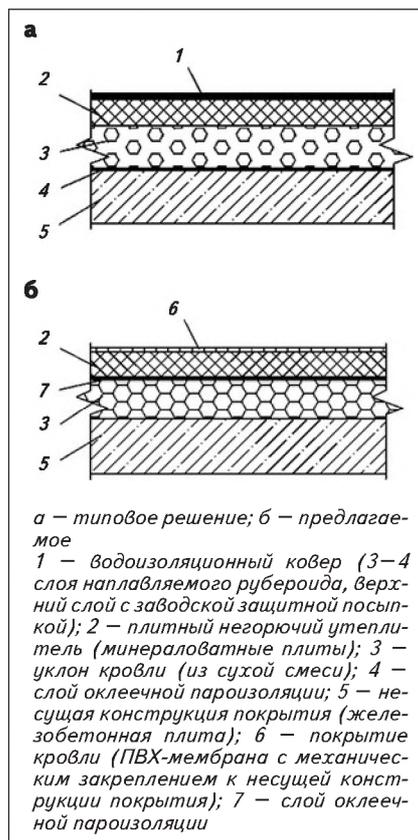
Конструкция совмещенного покрытия с прямым размещением слоев
